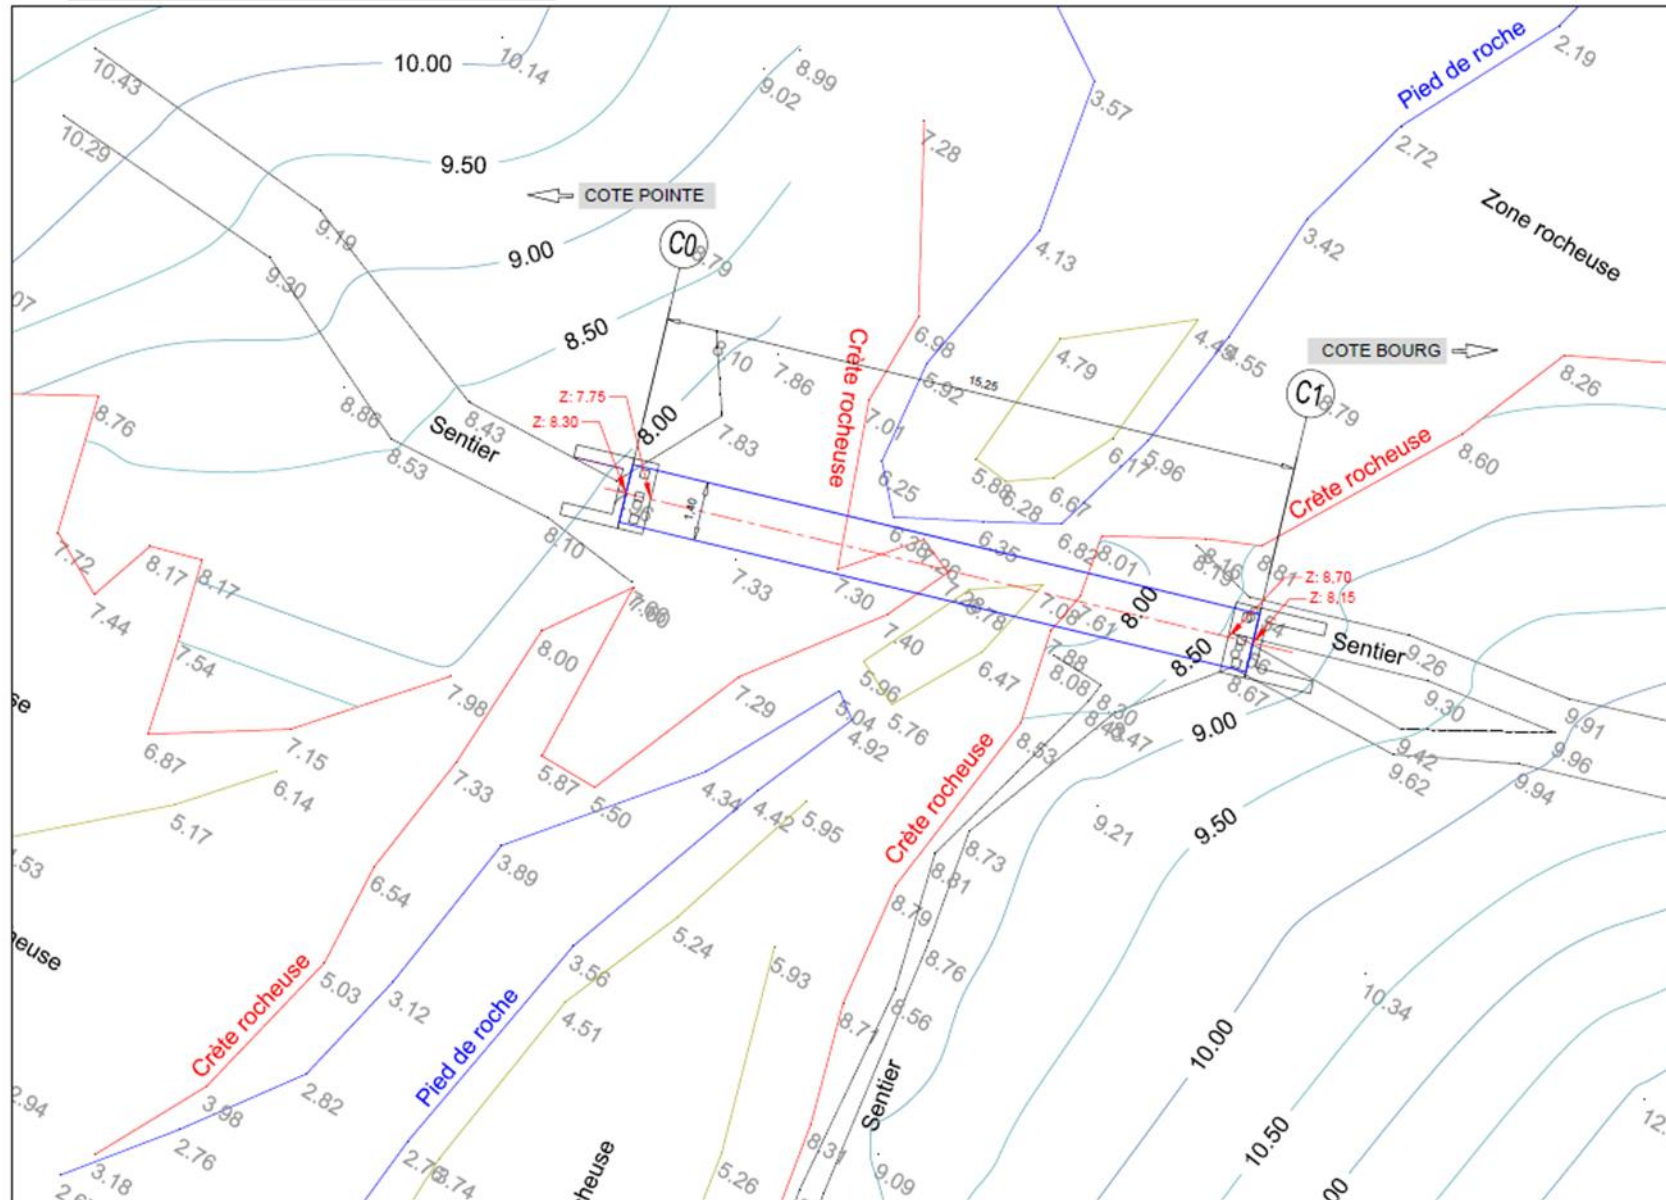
Ouvrage de la pointe du Château : plans (source : Atelier Nāga)
